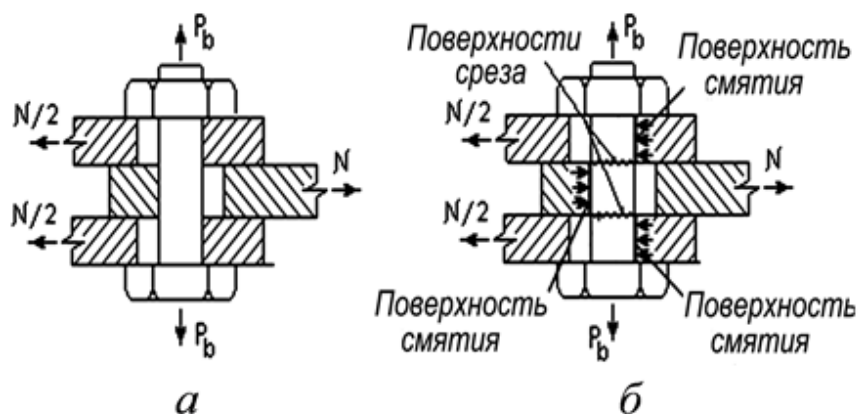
Этапы работы соединения на обычных болтах: а – работа болта на сдвиг; б – поверхности возможных разрушений.
